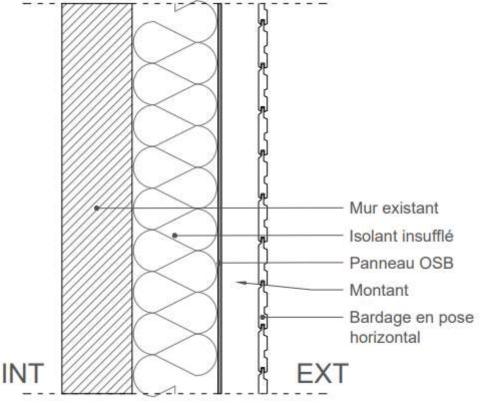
Vue en coupe du BYWalli avec bardage horizontal
